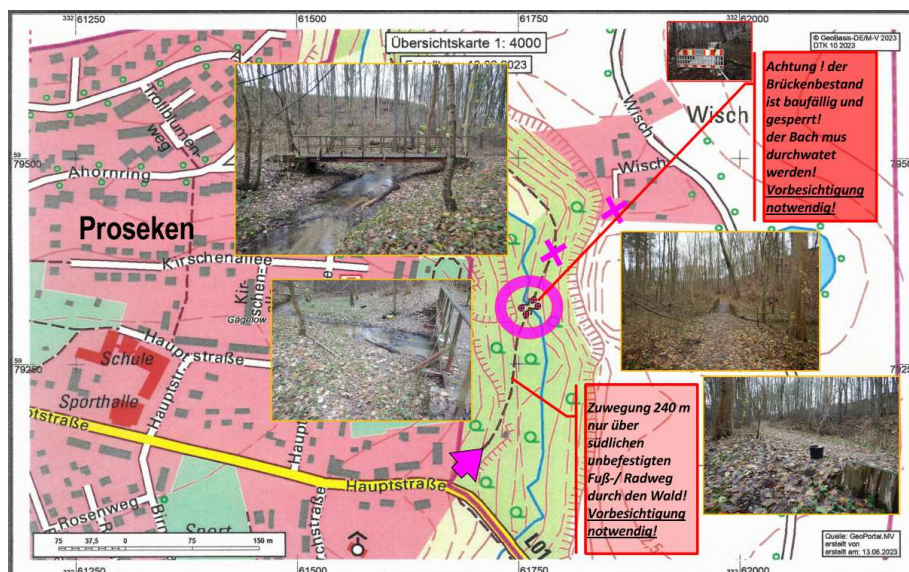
Übersichtslageplan Fußgängerbrücke Zierower Bach
